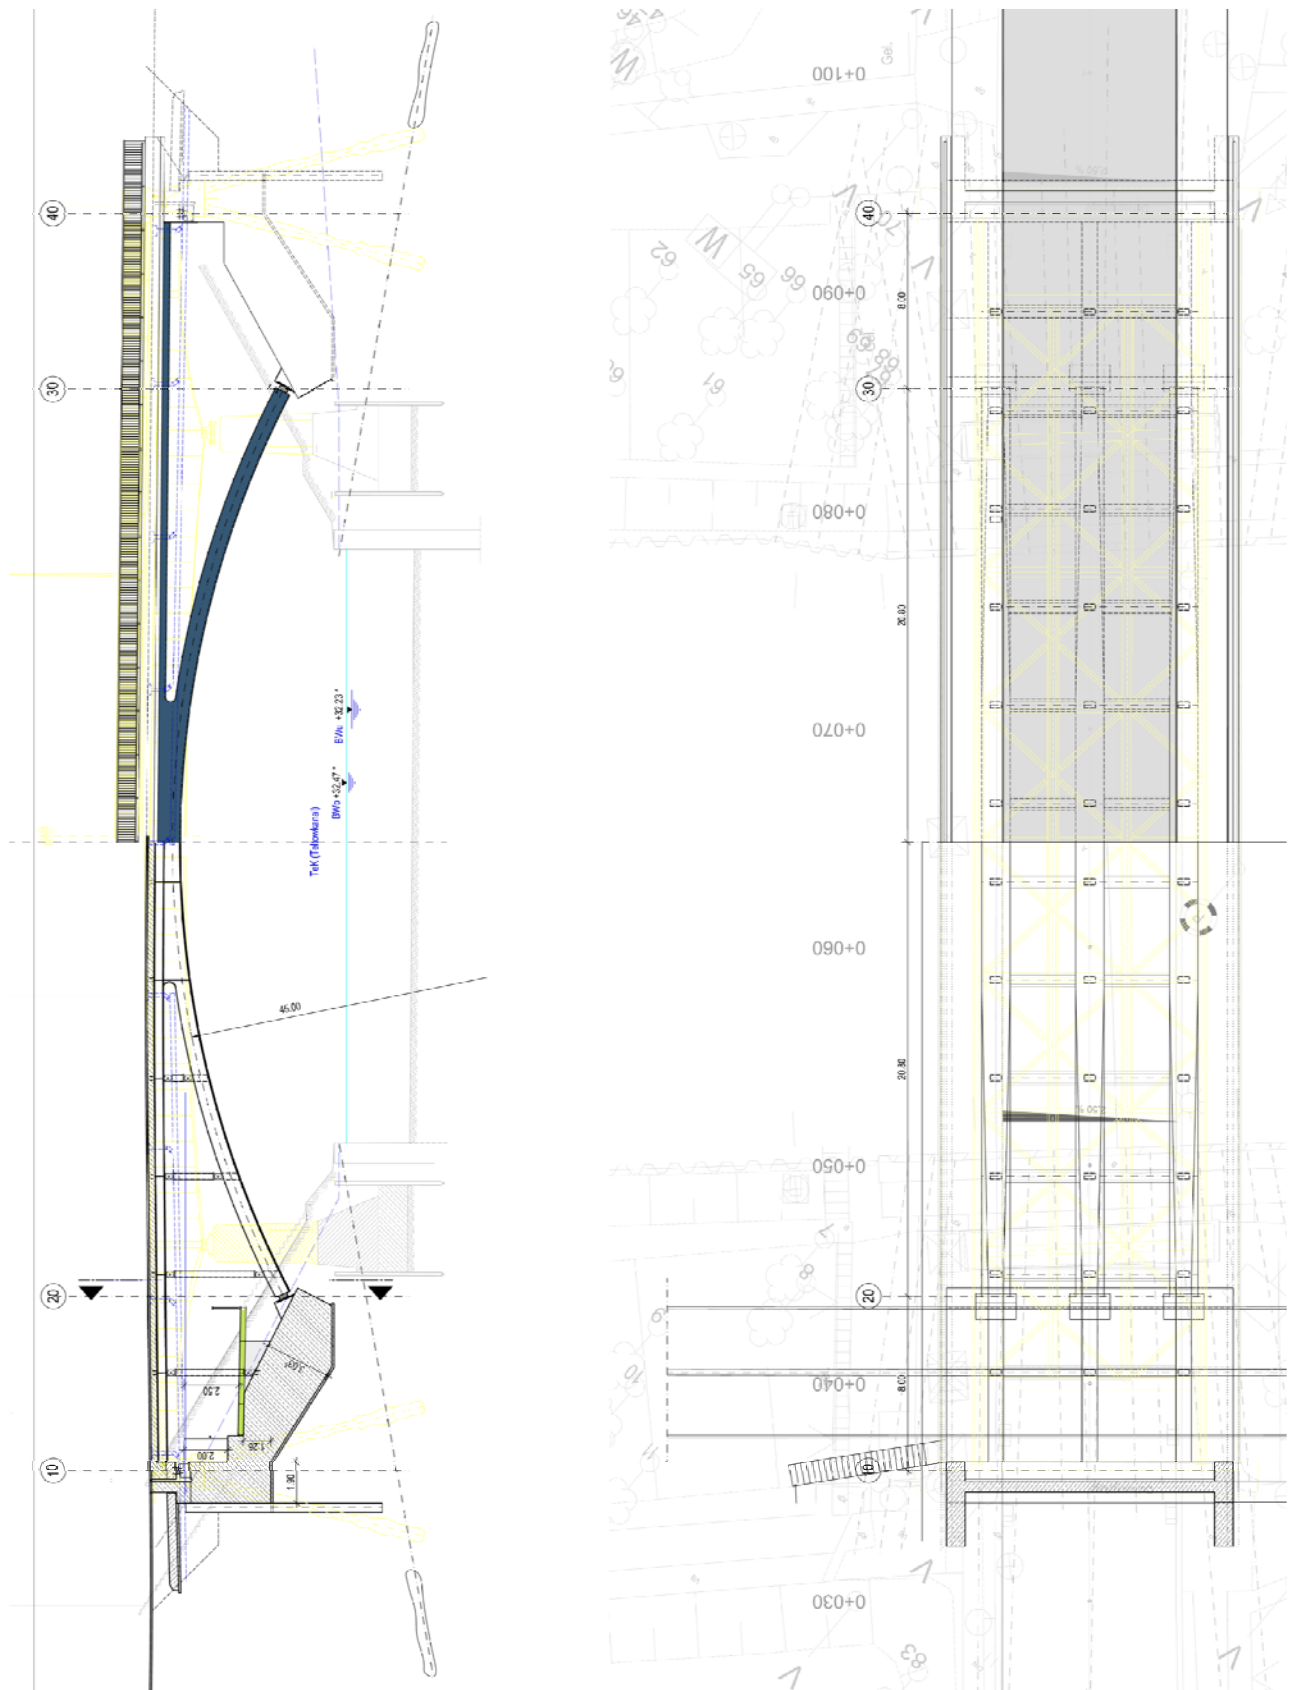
Längsschnitt und Grundriss des Ersatzneubaus der Techowbrücke aus [D 1]
